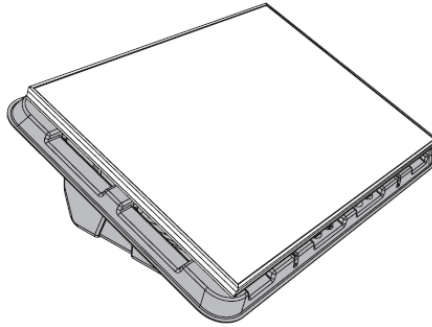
Sistema instalación módulos estructura tipo bañera
